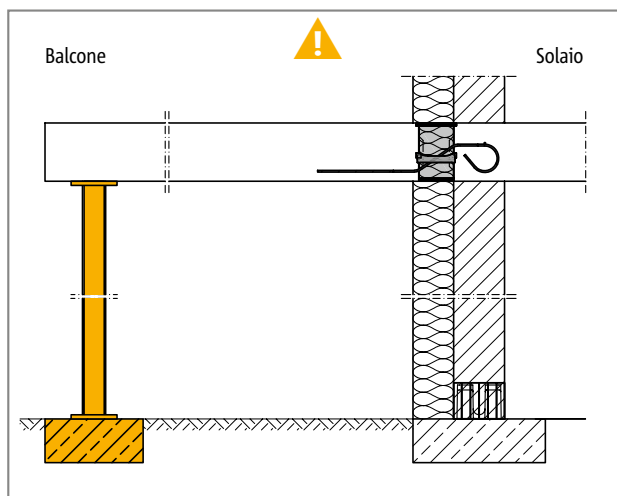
Schöck Isokorb® XT tipo QL: è necessario un appoggio continuo
